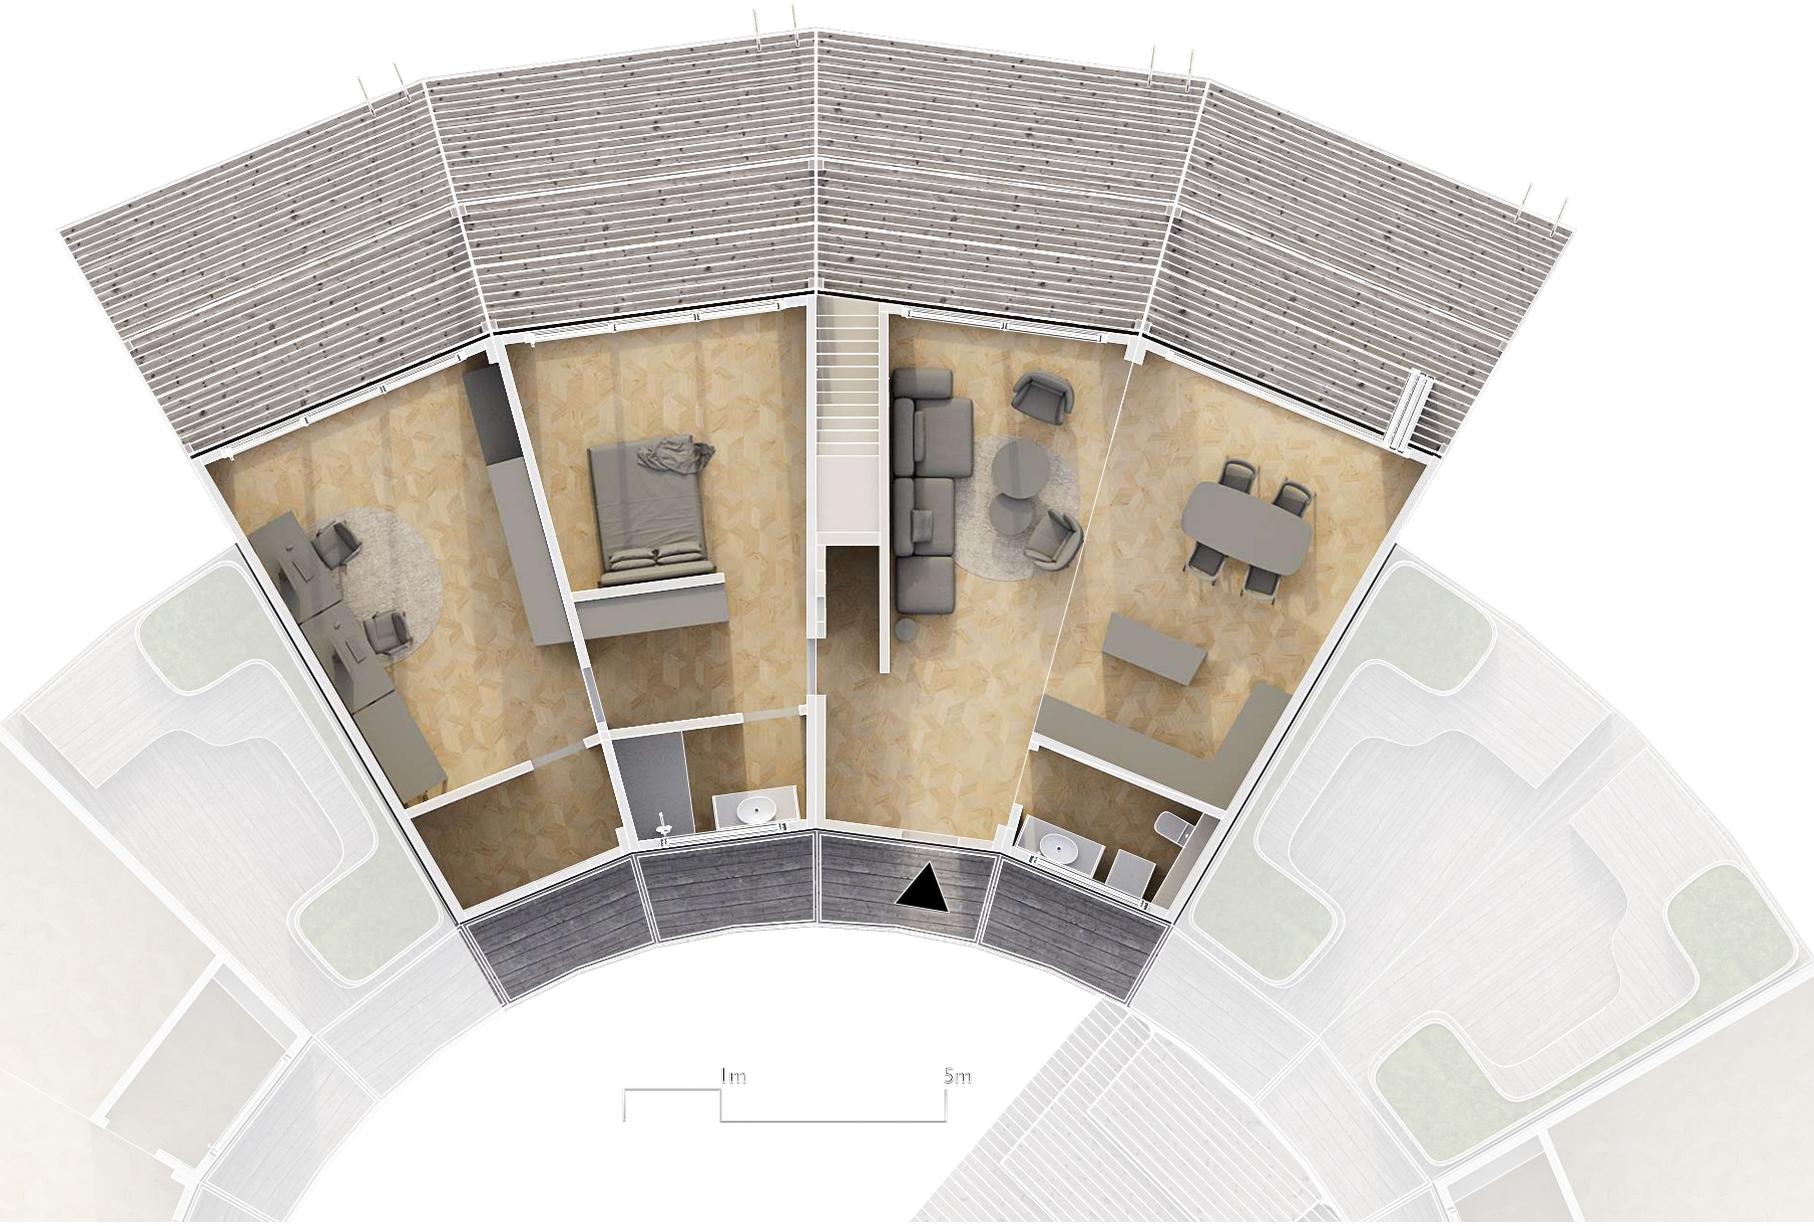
Grundriss-Variante C (120m²)- Erdgeschoss (von J.C. Aurel)
